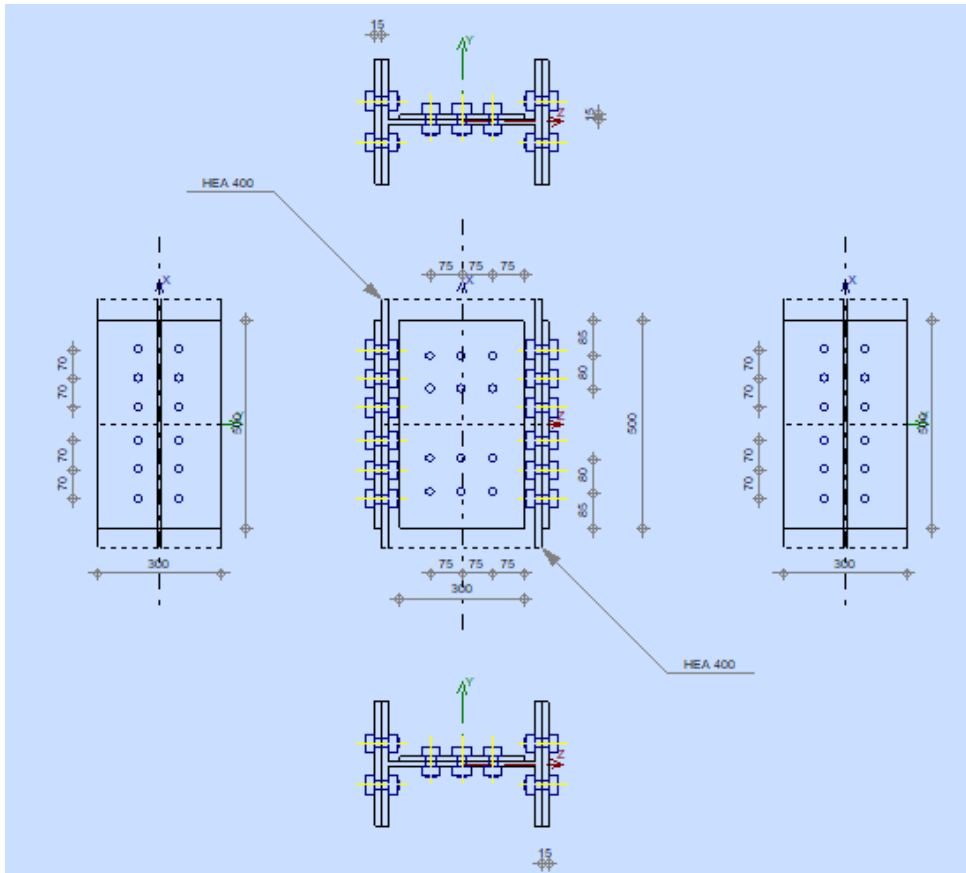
« Schéma d'assemblage poteau-poteau fait par Robot »
